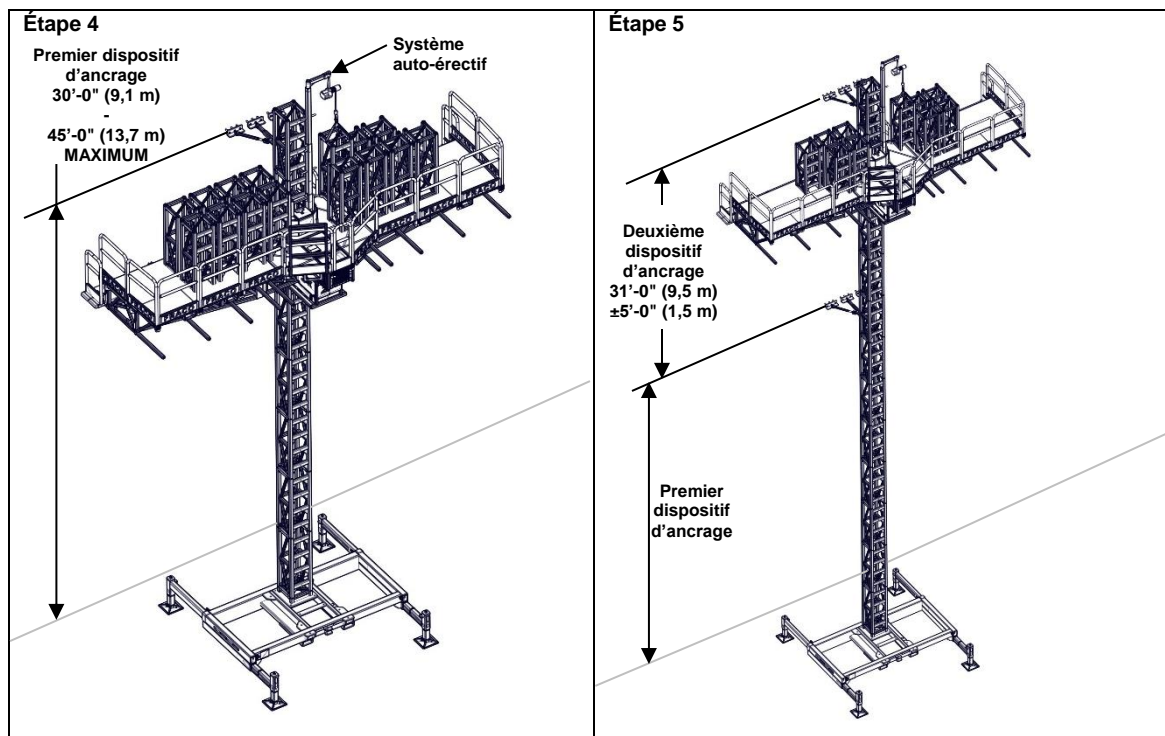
Installation mâts et ancrages sur base autoportante, auto-érectif (optionnel)
